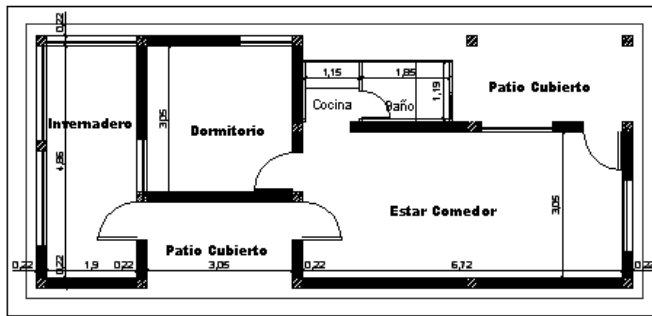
Vivienda ribereña en Quilmes, costa atlántica, Gran Buenos Aires. Planta y vista.
